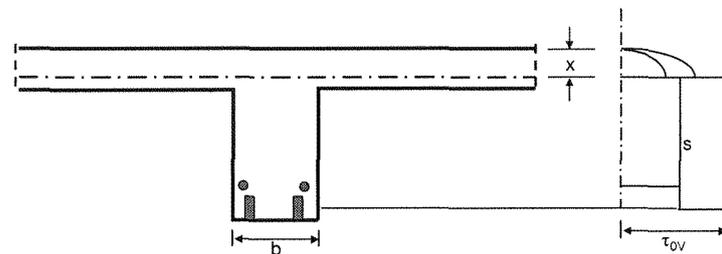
Ermittlung des Grundwertes der Schubspannung für Platten und Balken
